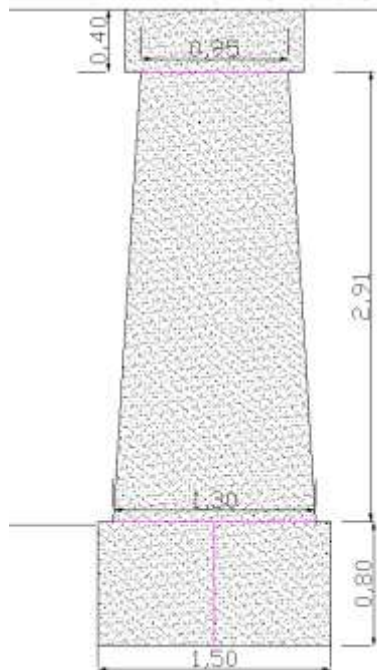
Detalle de columnas centrales del Puente Vehicular “El Playón”
